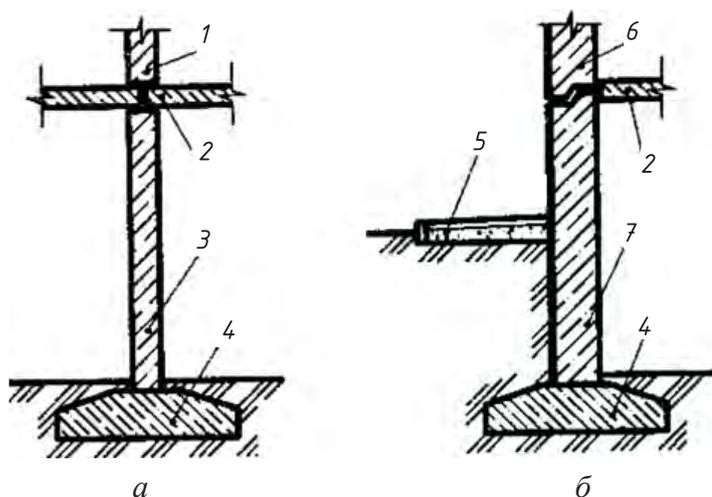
Фундаменты крупнопанельных зданий: *а* — разрез по внутренней стене; *б* — разрез по наружной стене: 1 — внутренняя стеновая панель; 2 — плита перекрытия; 3 — панель техподполья; 4 — фундаментная плита; 5 — отмостка; 6 — наружная стеновая панель; 7 — цокольная панель
